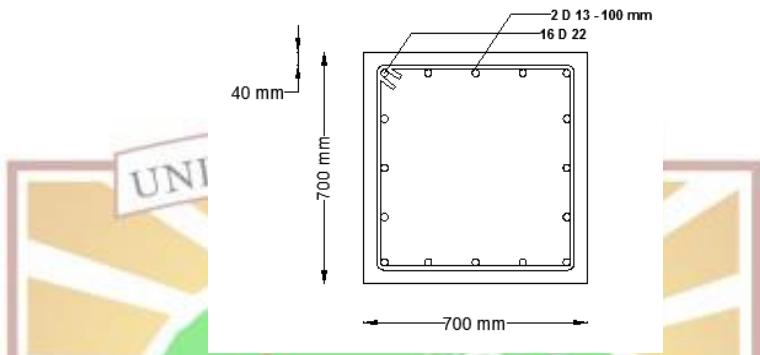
Detail Penulangan Balok Kantilever Bangunan 1a dan 1b
